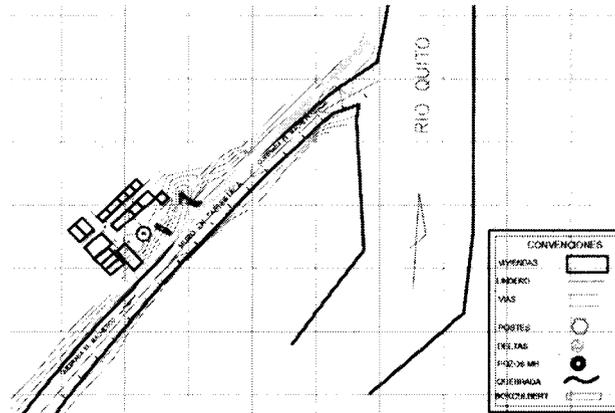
Distribución inicial secciones del río y ubicación del Muro
